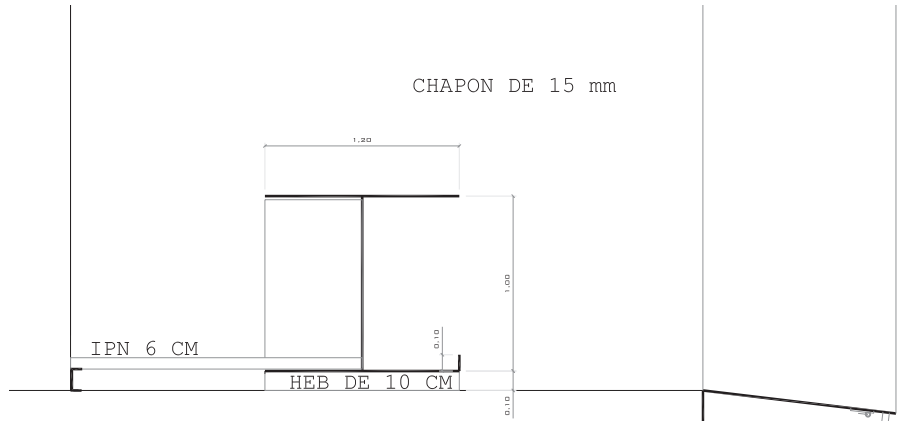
\_Detalles constructivos e imágenes banco corrido y pieza de mostrador en Nave Intermediae. Imágenes cedidas por el autor Arturo Franco.
